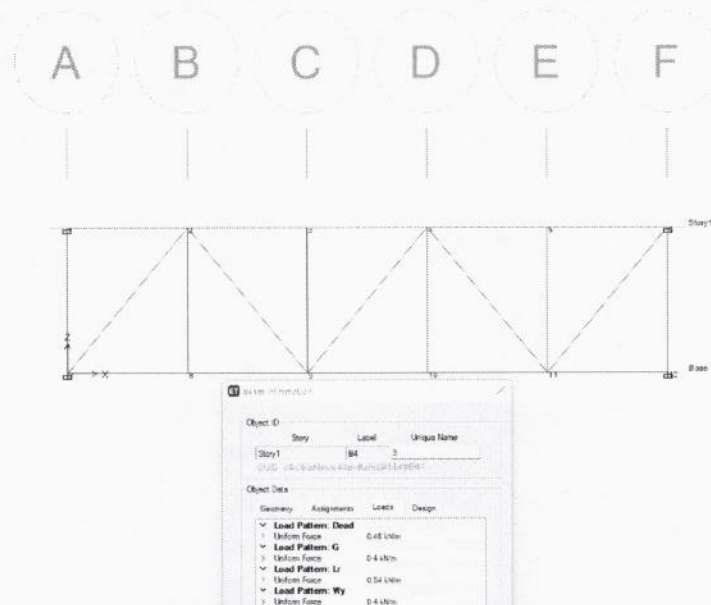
Modelo tramo de cubierta a evaluar y cargas con paneles solares
